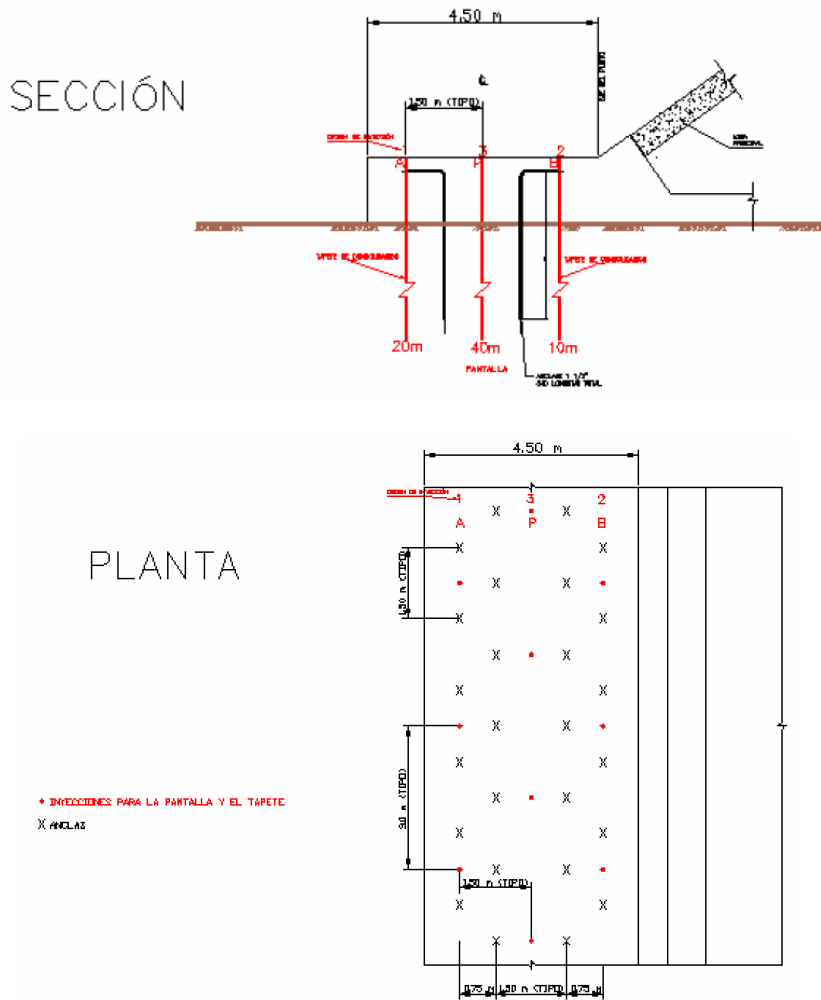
Detalle de inyecciones y anclas en la elevación 567-440 msnm del plinto (CFE, Informe 07-37-SGM/R).
